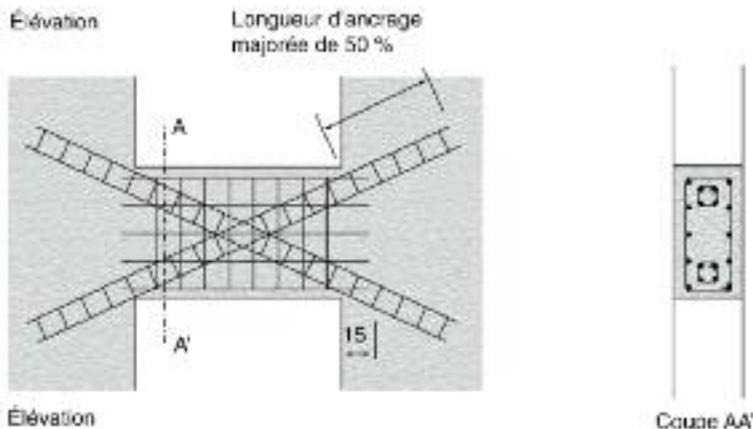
Armature des poutres-allèges reliant des voiles couplés
